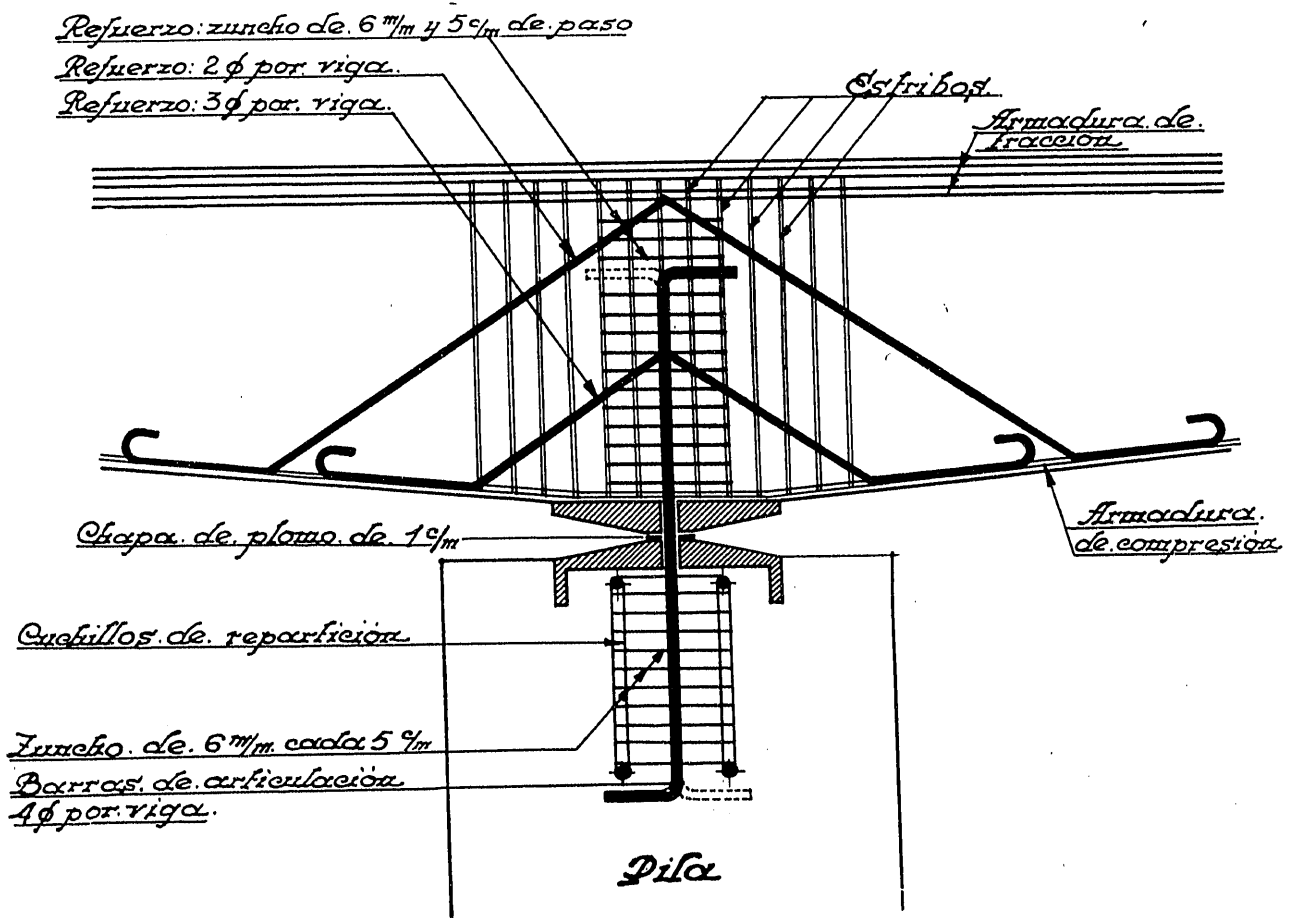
Refuerzo de la estructura en el apoyo de articulación fija
